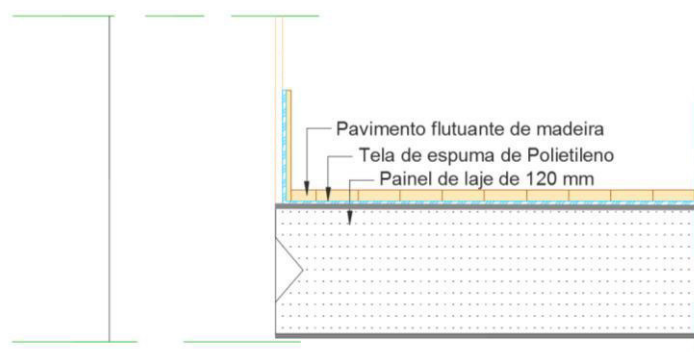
Pormenorização do pavimento no encontro com uma parede
